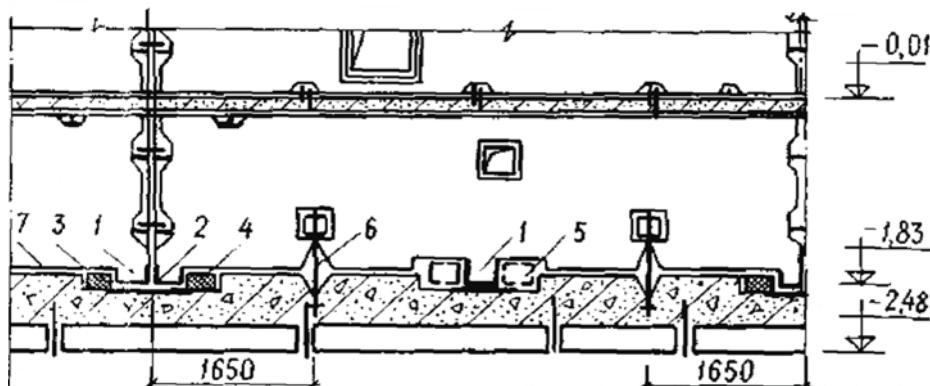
Схема скользящего шва крупнопанельных зданий:
